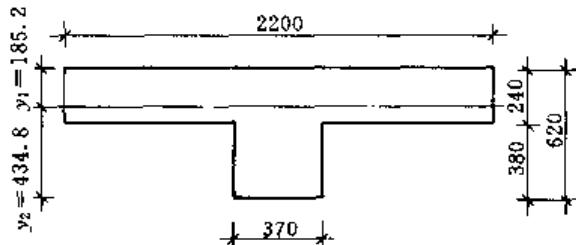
厂房窗间墙截面简图（单位：mm）
